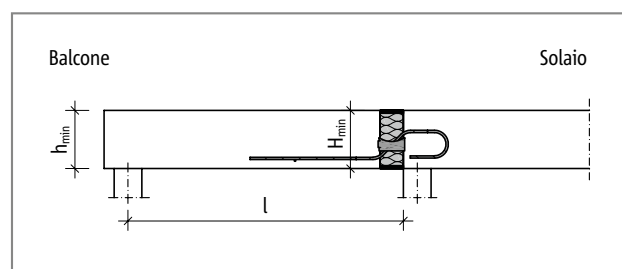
Schöck Isokorb® T tipo QP-V1 e QP-V3: schema statico
